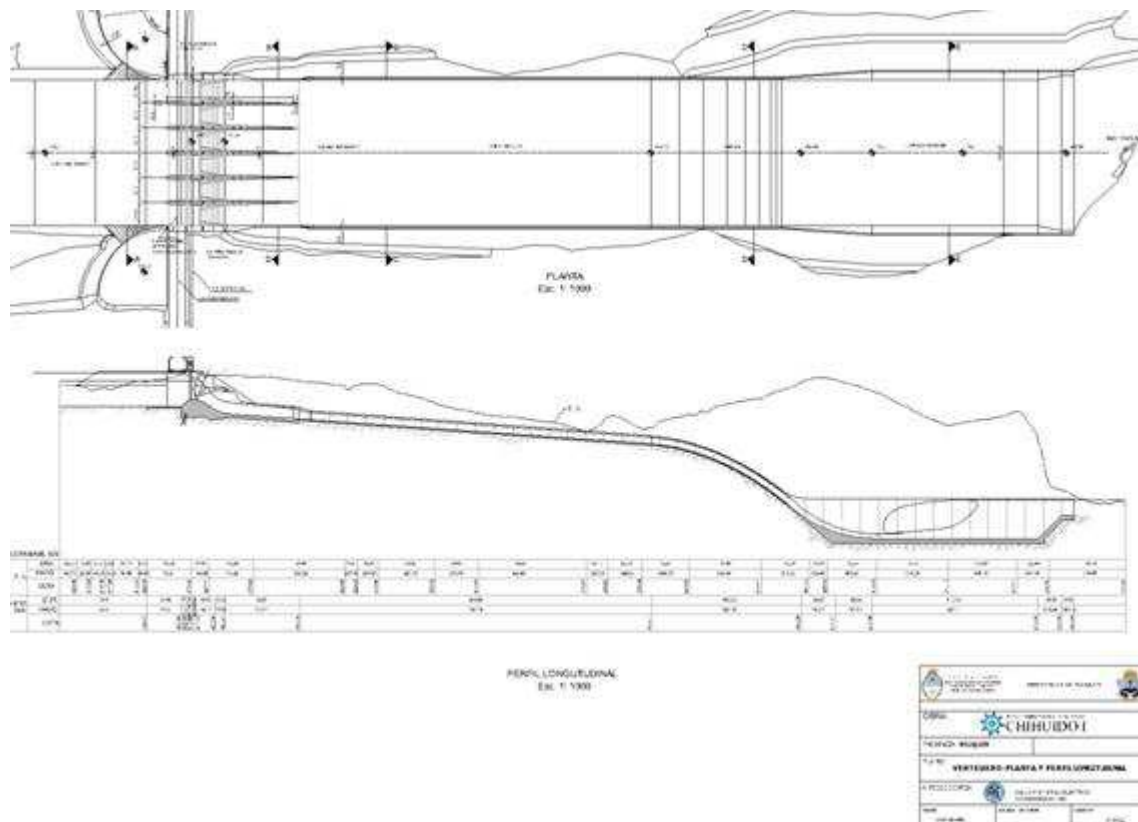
Planimetría y Perfil Longitudinal del vertedero, rápida y cuenco dissipador
